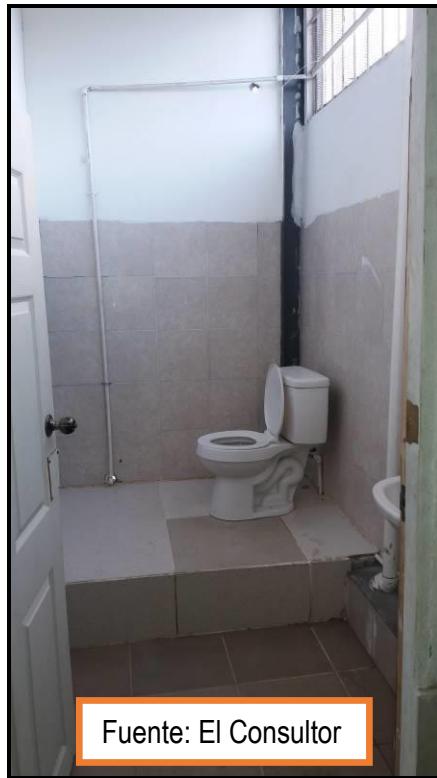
Vista de los baños higiénicos existentes y que está ubicado en la planta alta.
